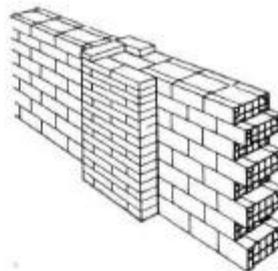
Pilastri o lesene di mattoni pieni possono essere facilmente intercalati nelle murature di Blocchi S.
